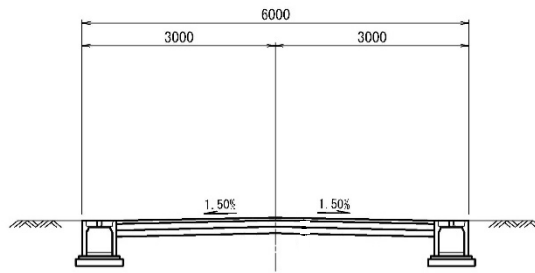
(9) 標準断面图 (特殊道路 幅員 6.0m)
